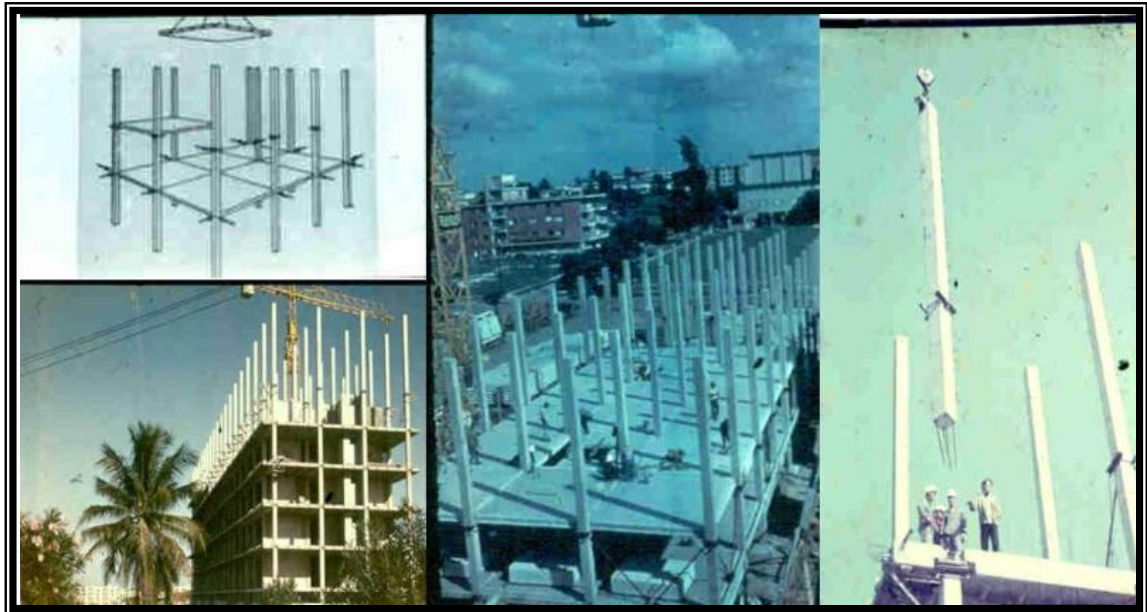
23 Célula básica del sistema IMS. Una vez montadas las columnas, la losa se iza y coloca sobre elementos de apoyo temporal para luego postensionar longitudinalmente al edificio.
